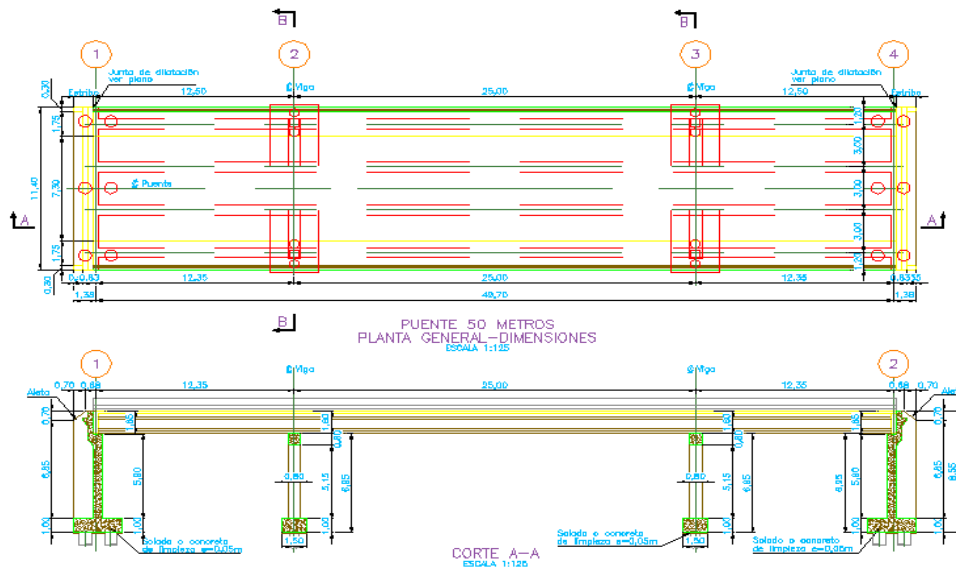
Sección Longitudinal en planta y corte – Puente 3
